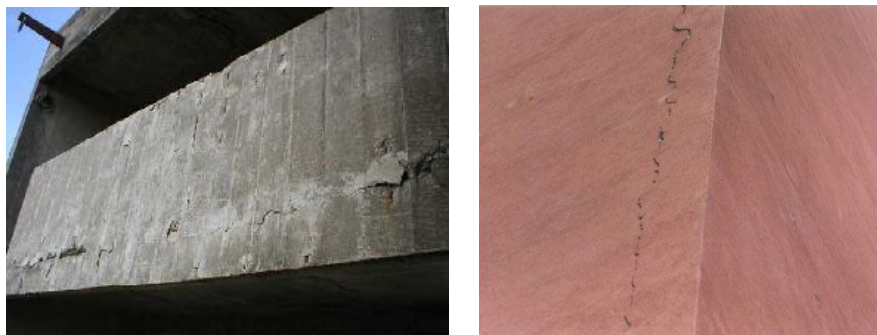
Fissuras em fachadas de edifícios [44]
